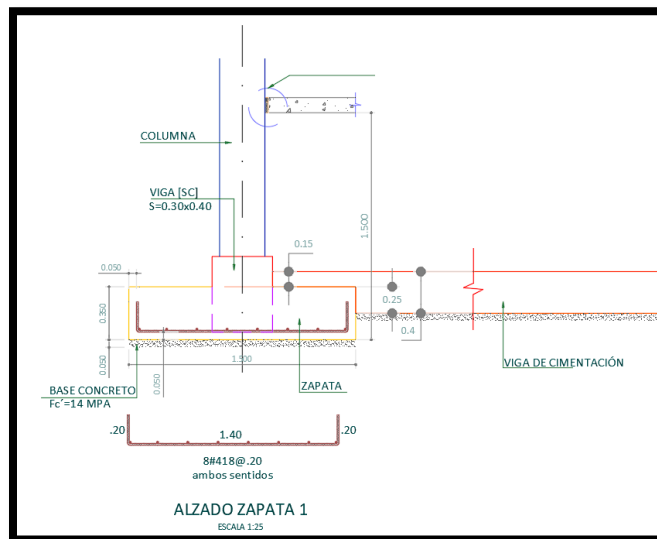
Vista de corte lateral de la cimentación. Fuente: Diseño estructural.
